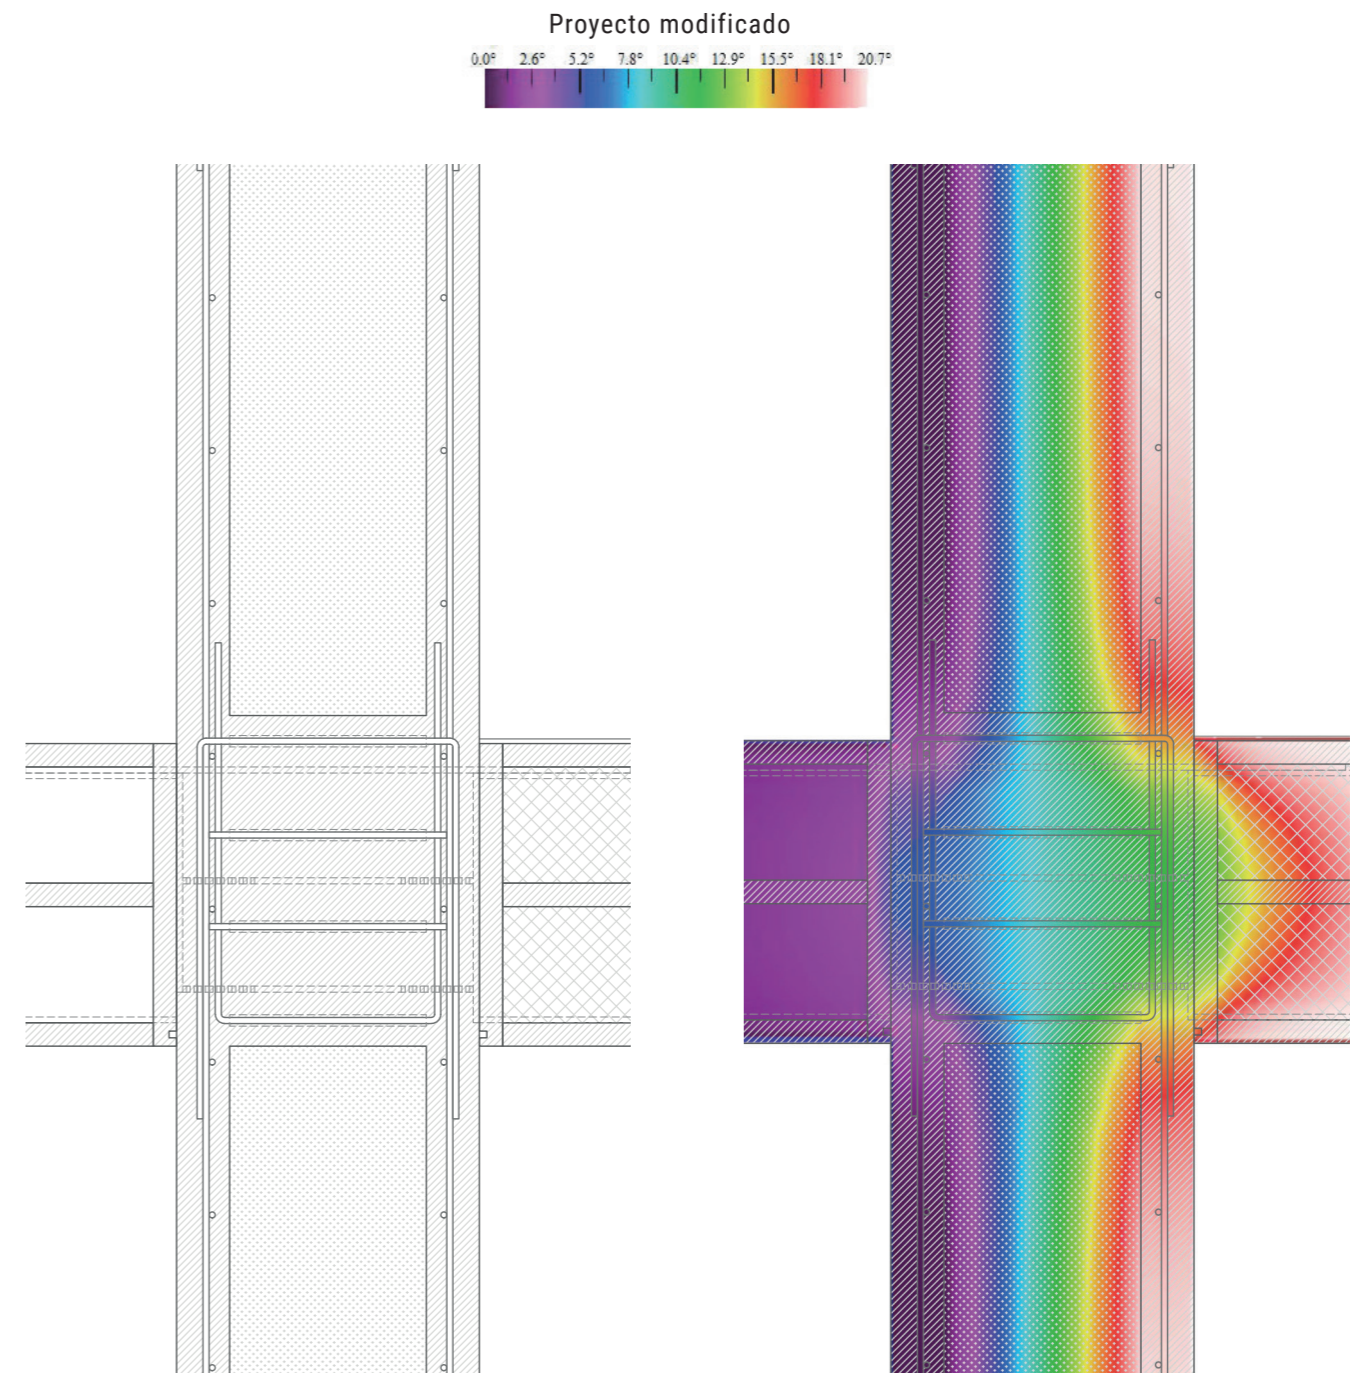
Detalle muro-forjado proyecto modificado E1:10
